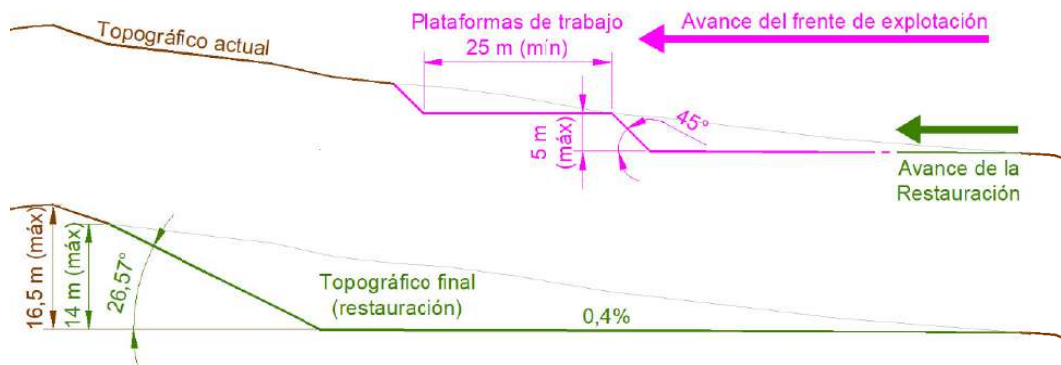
Modelo-tipo estructural en la extracción y en la restauración.
